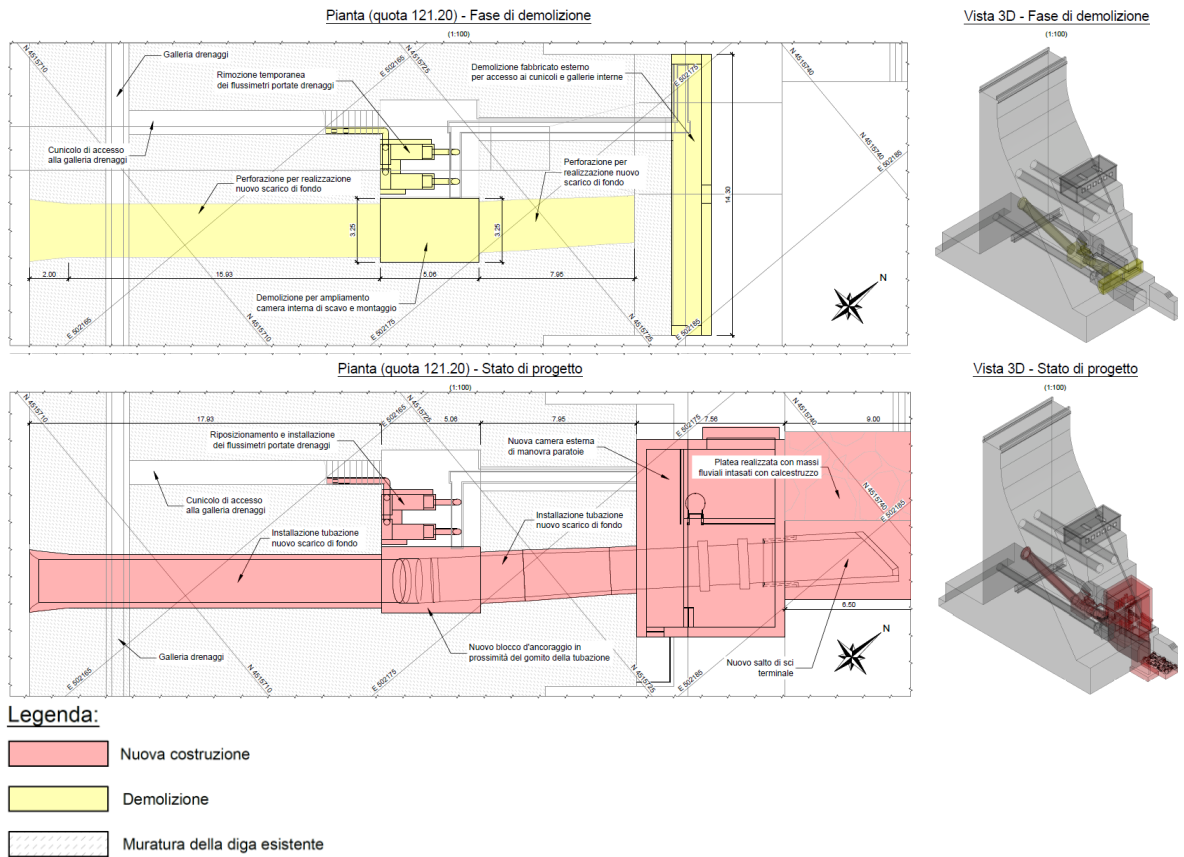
Rappresentazione planimetrica e tridimensionale della fase di demolizione e costruzione dello scarico di fondo e della nuova camera esterna di manovra delle paratoie
